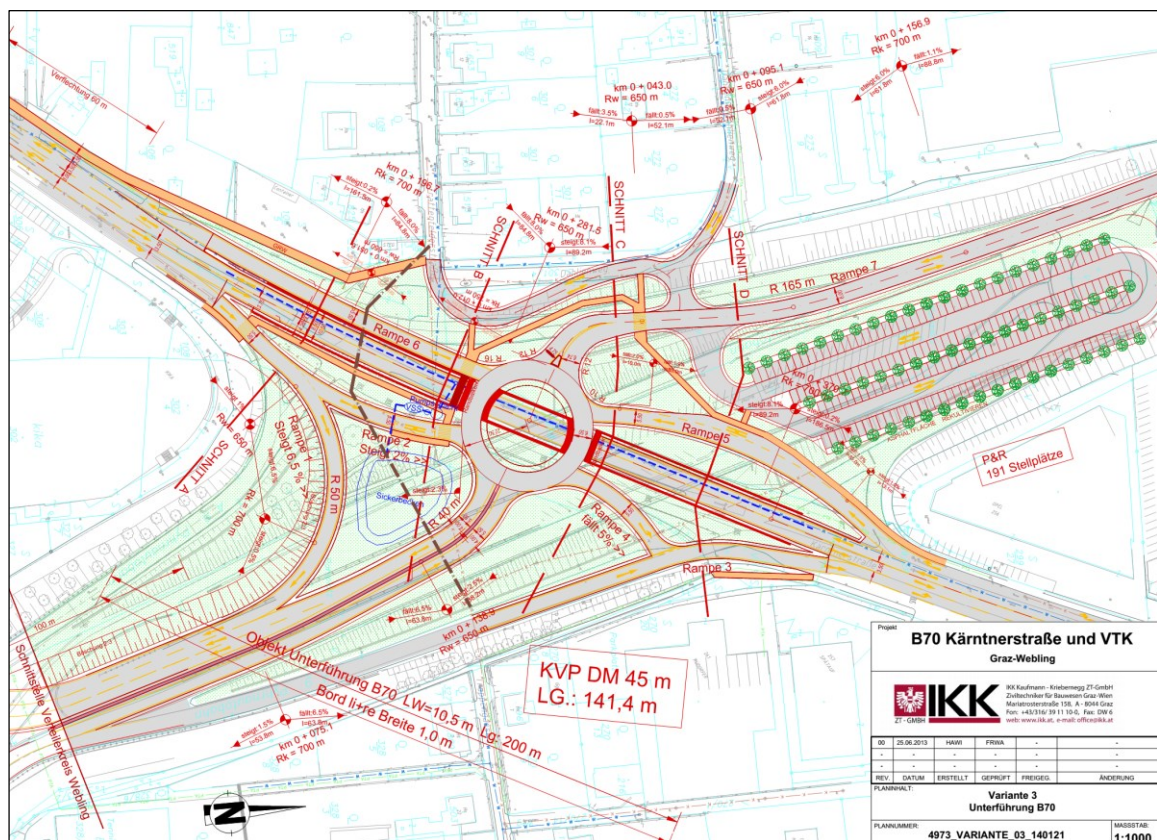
Lageplan Variante 3 - Unterführung Kärntnerstraße
